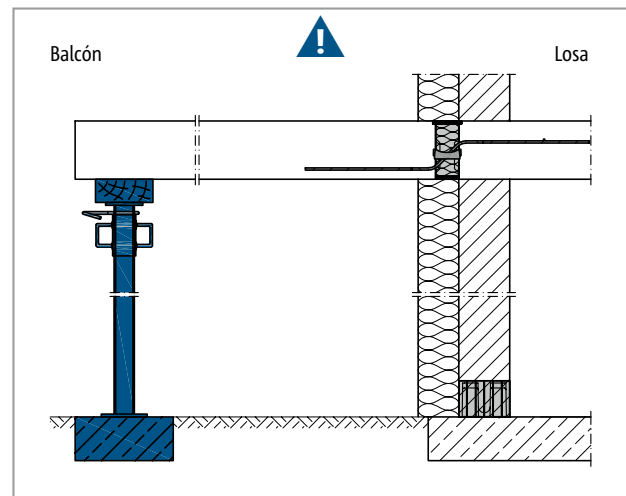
Schöck Isokorb® T tipo Q: Se requiere apuntalamiento continuo
